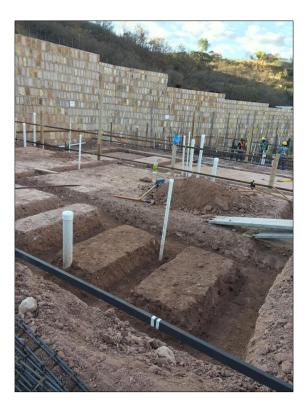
Excavación de fundaciones en vivienda 40 de "Villa Los Nopales'
